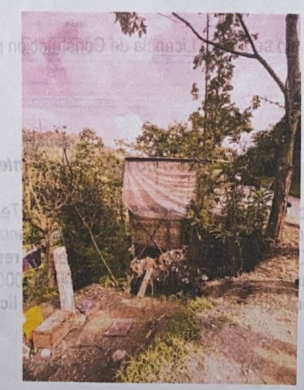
Vivienda en estructura de guadua con cerramiento en esterilla.
